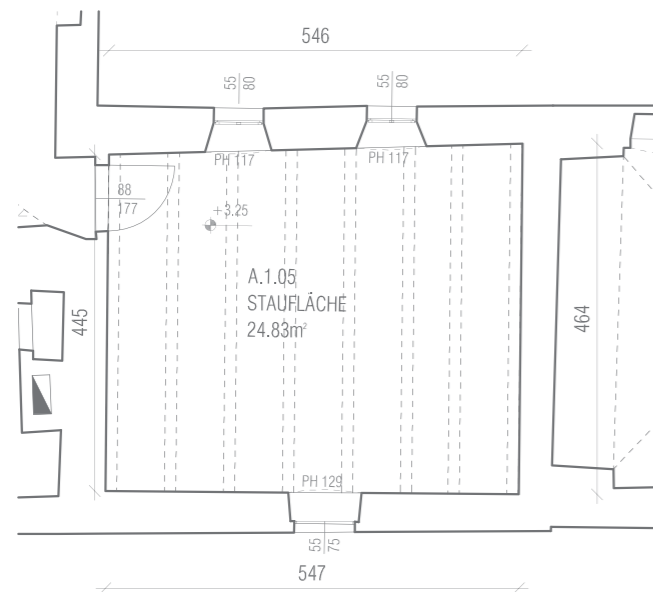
Grundriss Raum A.1.05_1:100
